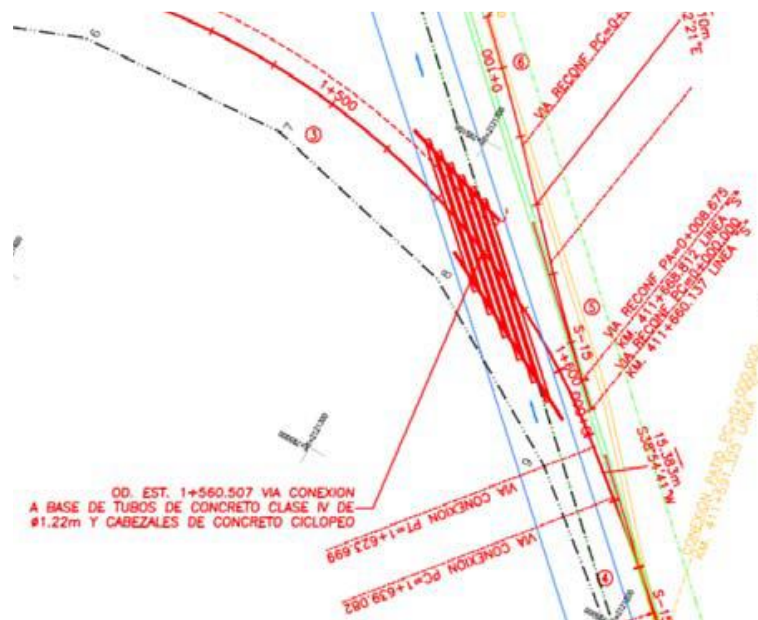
Obra de drenaje propuestas para la vía de conexión km 1+560.5.
